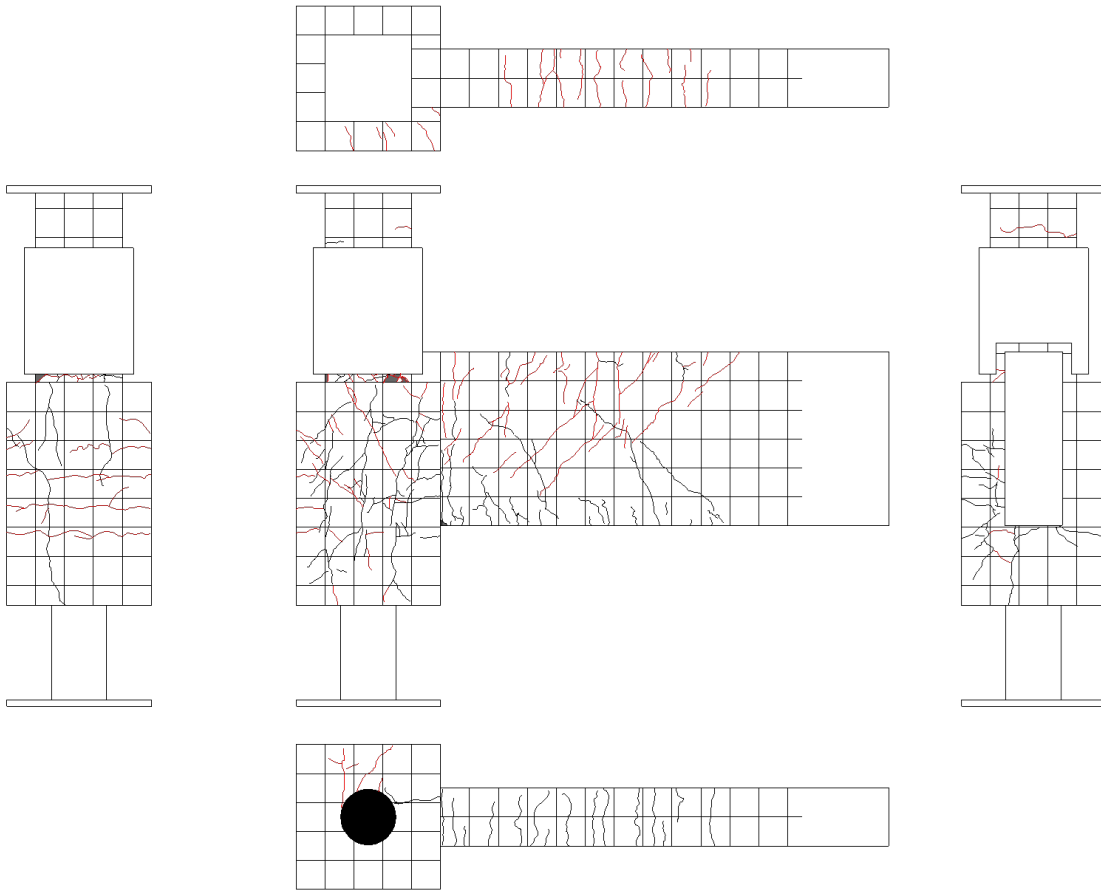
3. 49 試験体 A-1 ひび割れ状況 (6Cycle)
